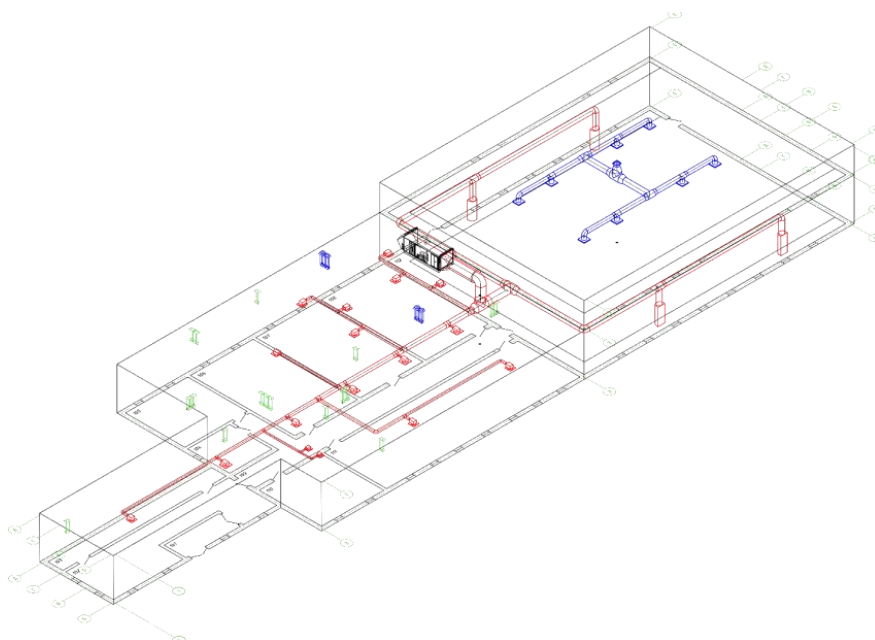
3D-план системы вентиляции спорткомплекса
